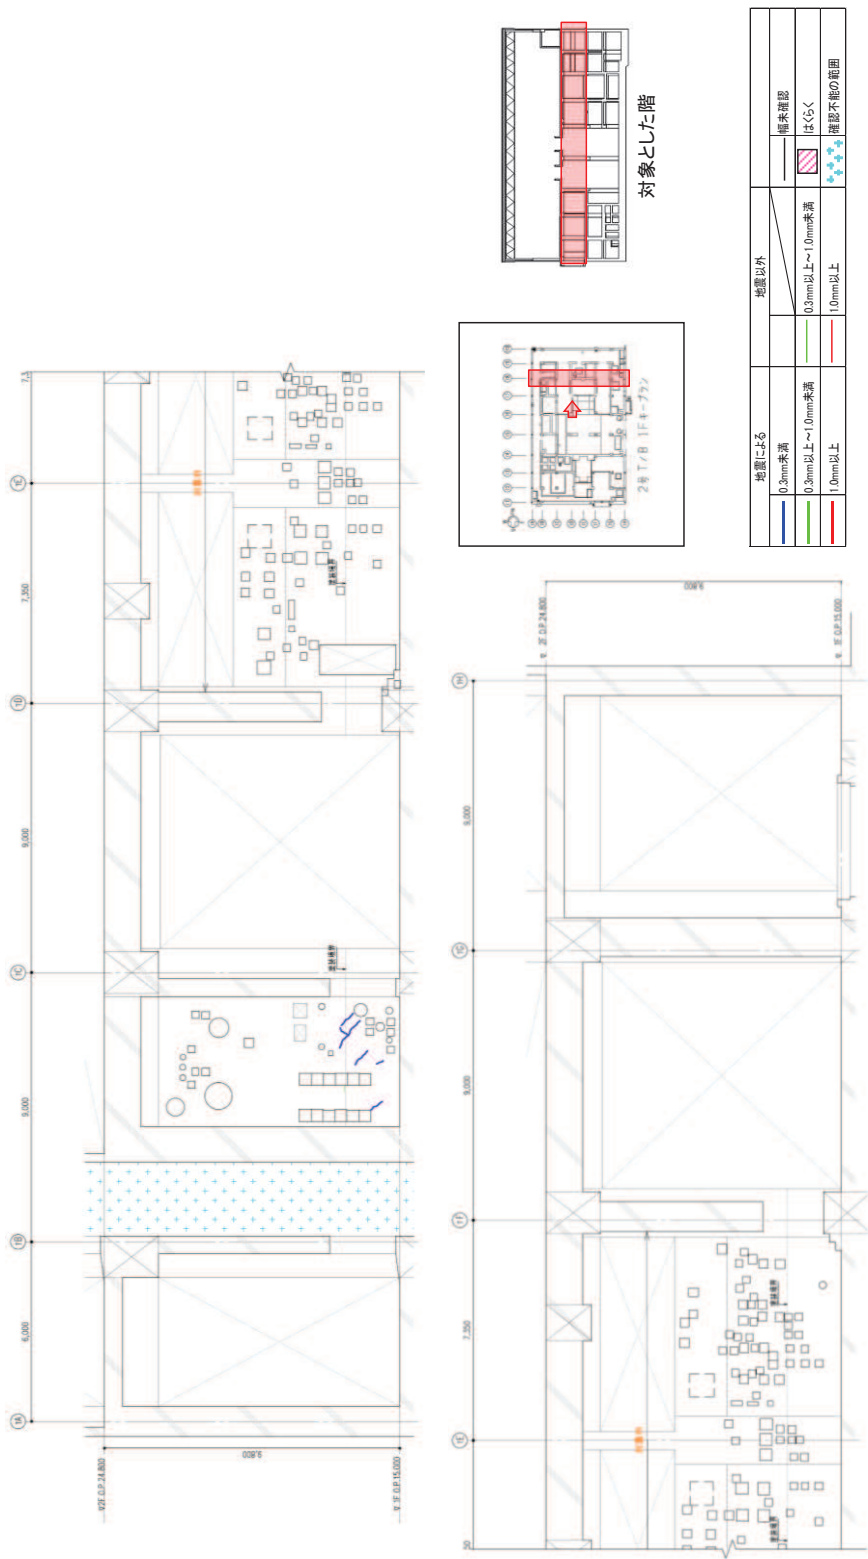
タービン建屋のひび割れ分布 耐震壁 (40) 1 階 T8 通り
